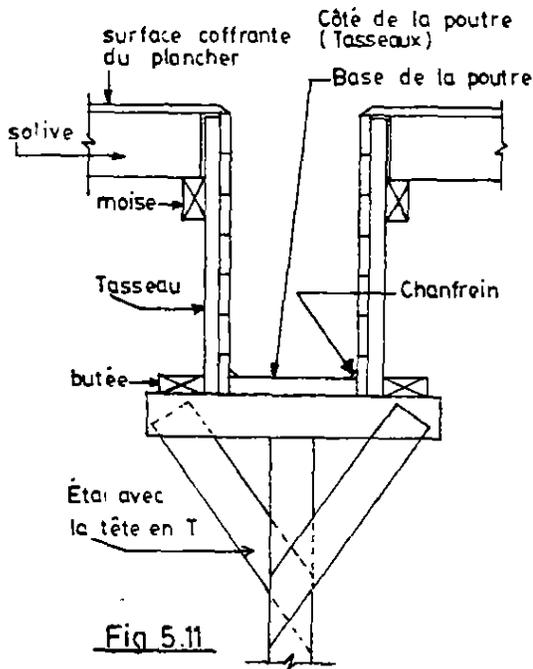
à 5.14 Coupes schématiques de coffrage de poutres
